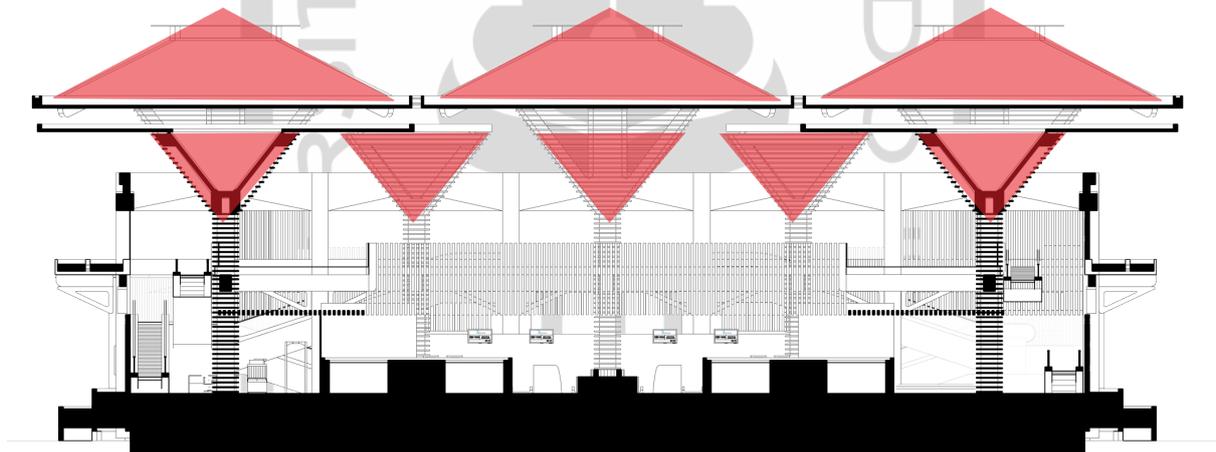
Selubung Kolom/Plafond Interior Bangunan Gedung Terminal Bandar Udara Wiriadinata
